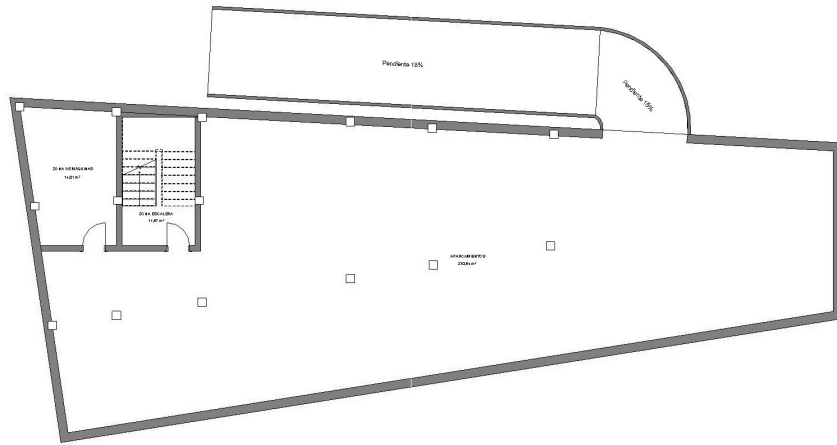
Esquema de la promoción: Planta Sótano. Elaboración propia.
